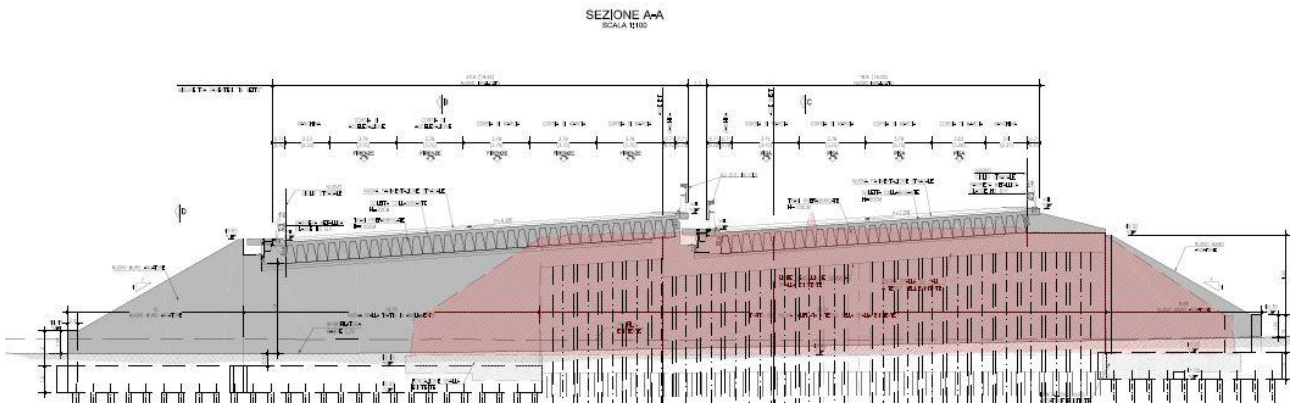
Sezioni tipo progetto ampliamento sottovia.
